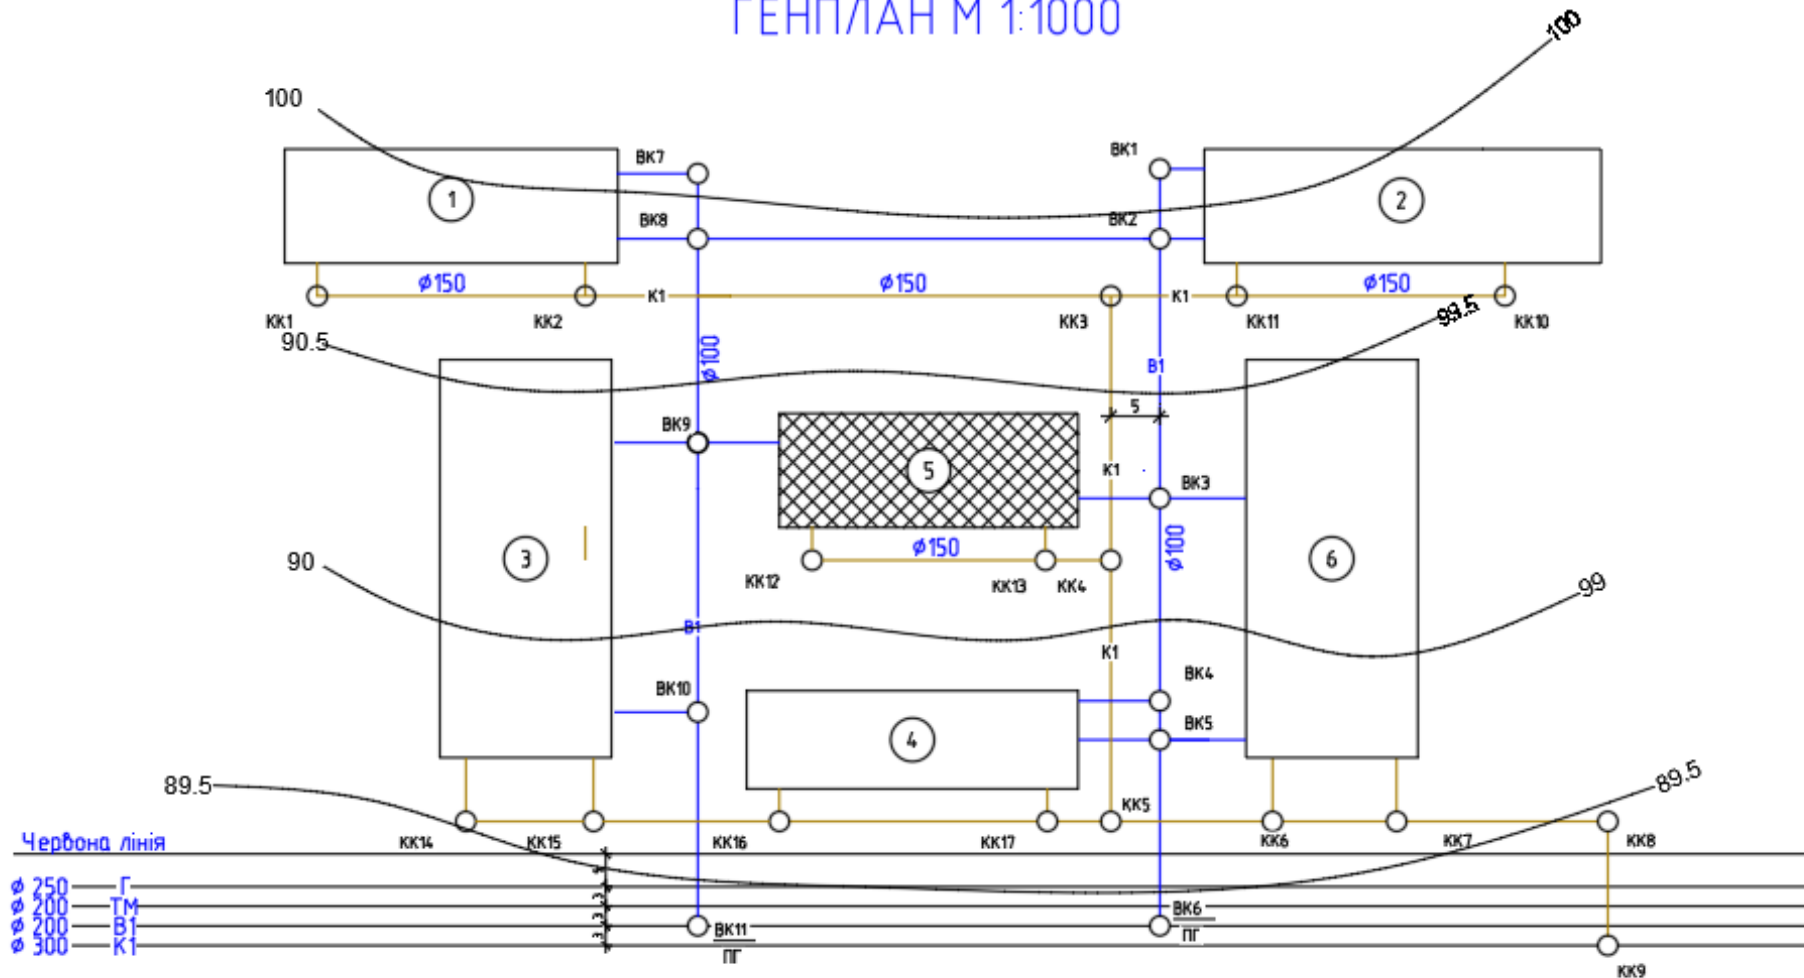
Генплан міста з перетинами каналізаційного трубопроводу з іншими системами
